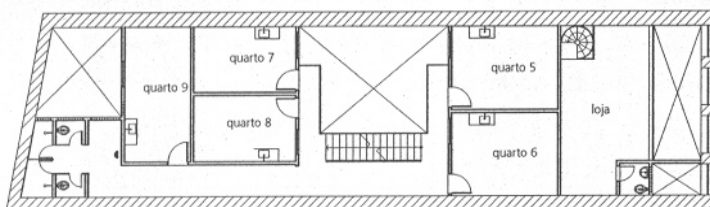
Cortiço na rua Sacadura Cabral, 295 – Planta baixa do primeiro pavimento (SECRETARIA, 2000, p. 24).
